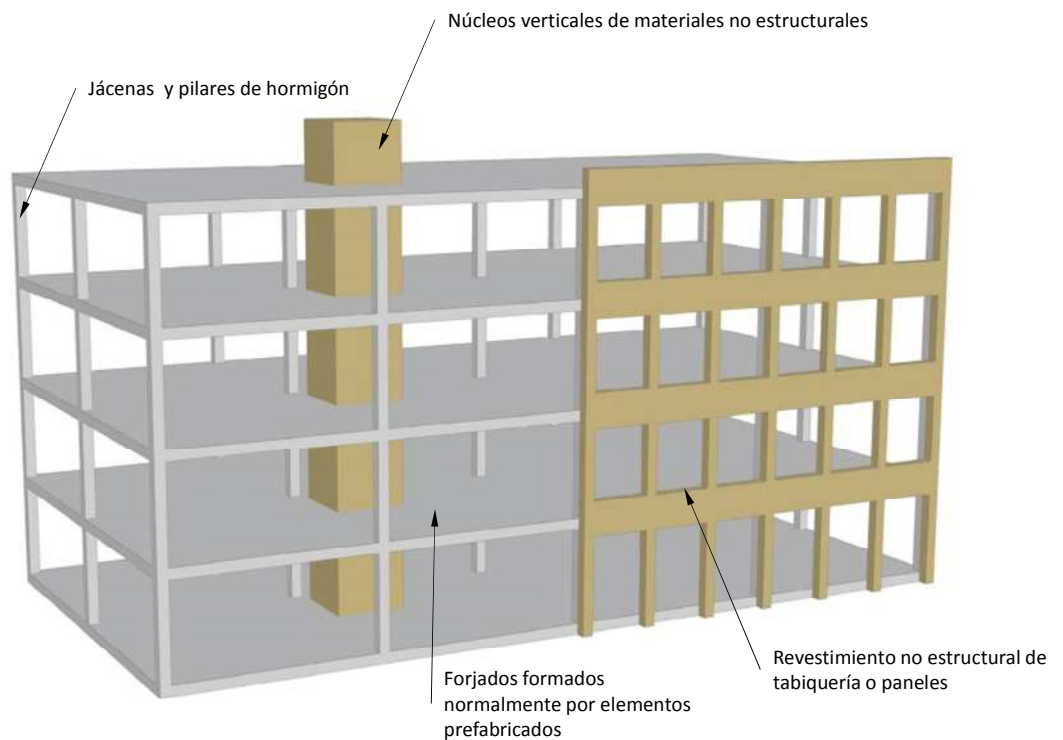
Estructura tipo C1, con pórticos de hormigón.
